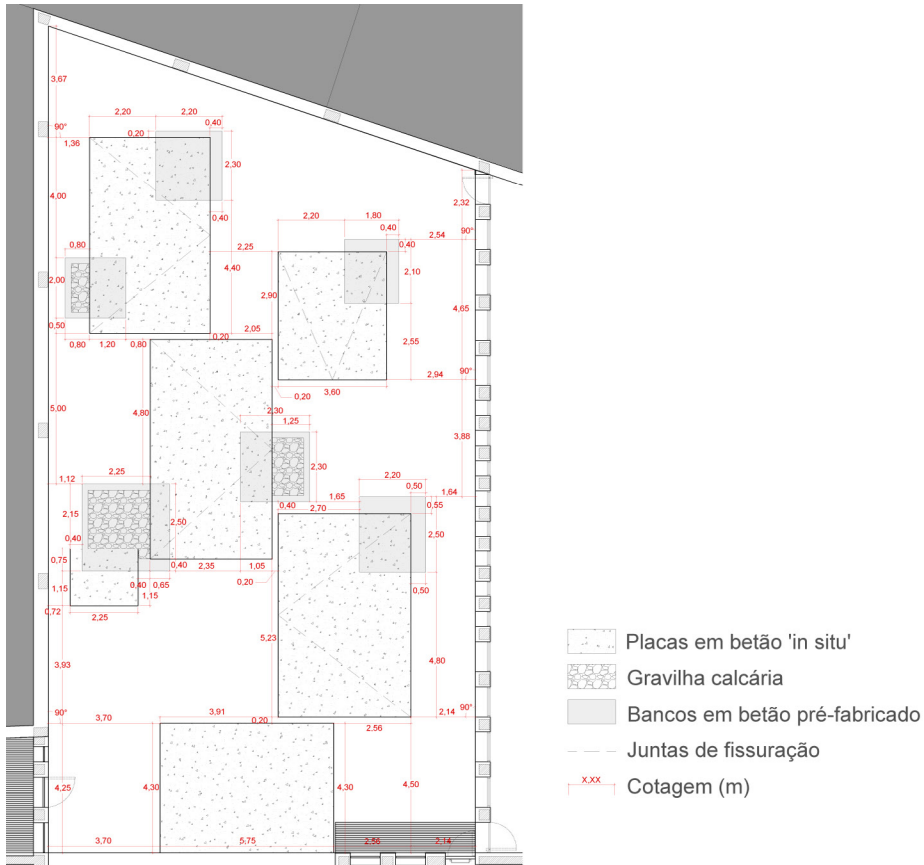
Planta de pavimentos, revestimentos e implantação planimétrica.
